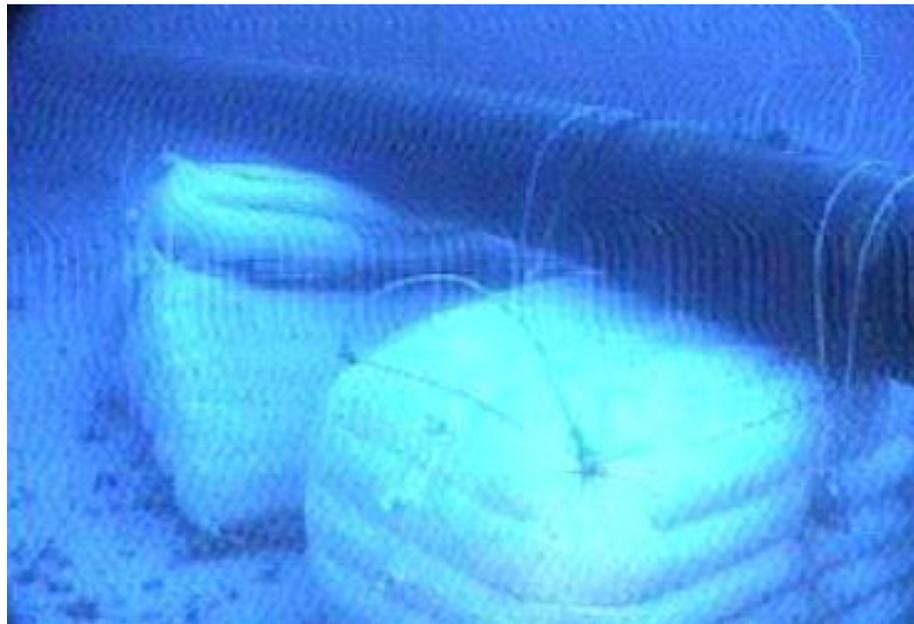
Exemplo de calçamento com “grout bag”.
